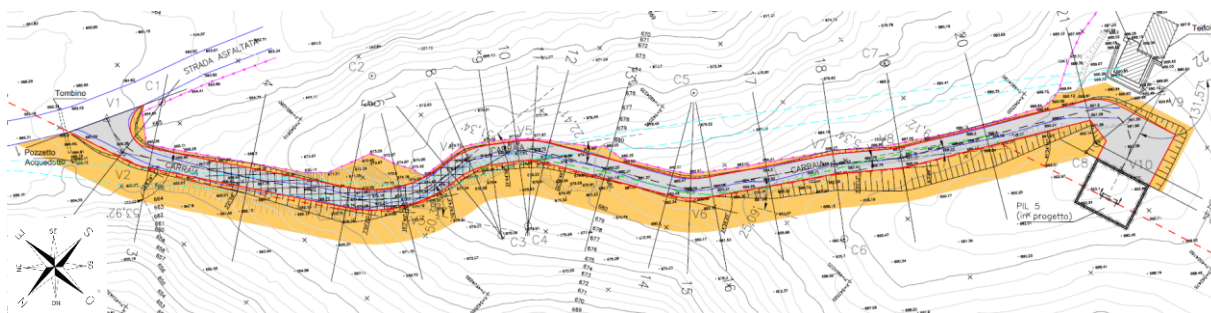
Sviluppo planimetrico della strada di nuova realizzazione ID32
